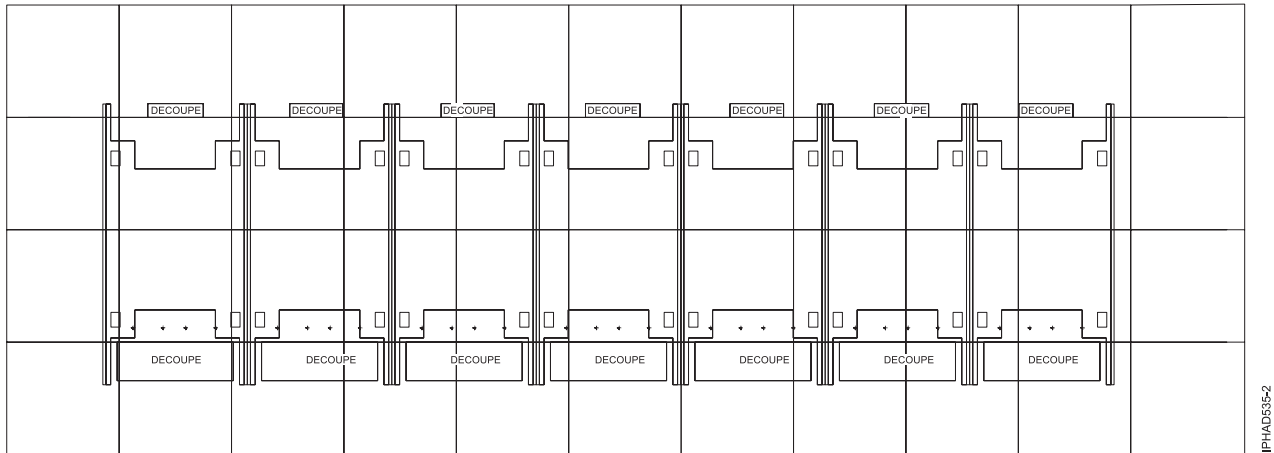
Découpe de dalle de plancher de 610 mm avec plusieurs cadres (premier cadre centré sur la dalle de plancher)
